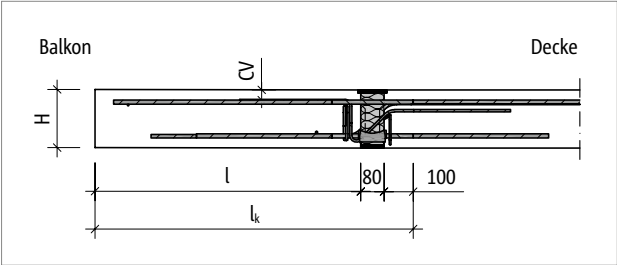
Schöck Isokorb® T Typ C: Statisches System
